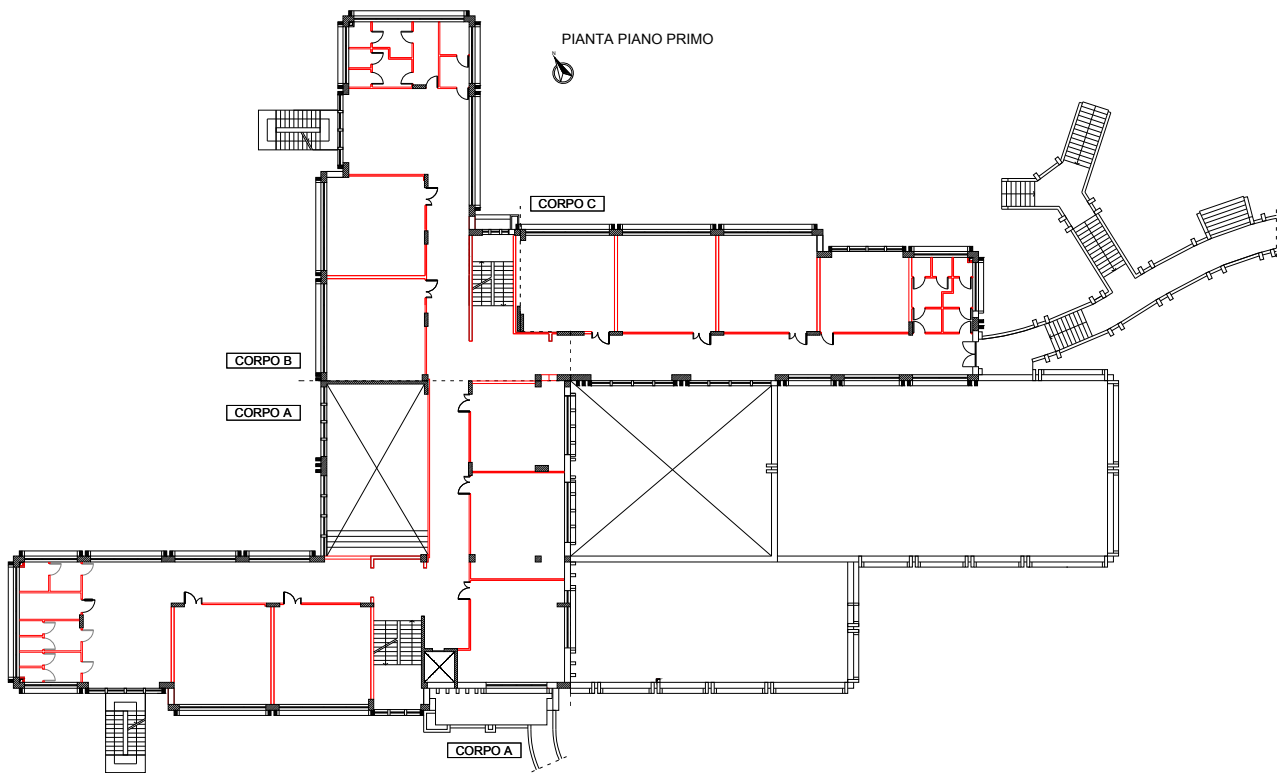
Installazione di Tramezzature Antisismiche – Localizzazione dell'intervento
